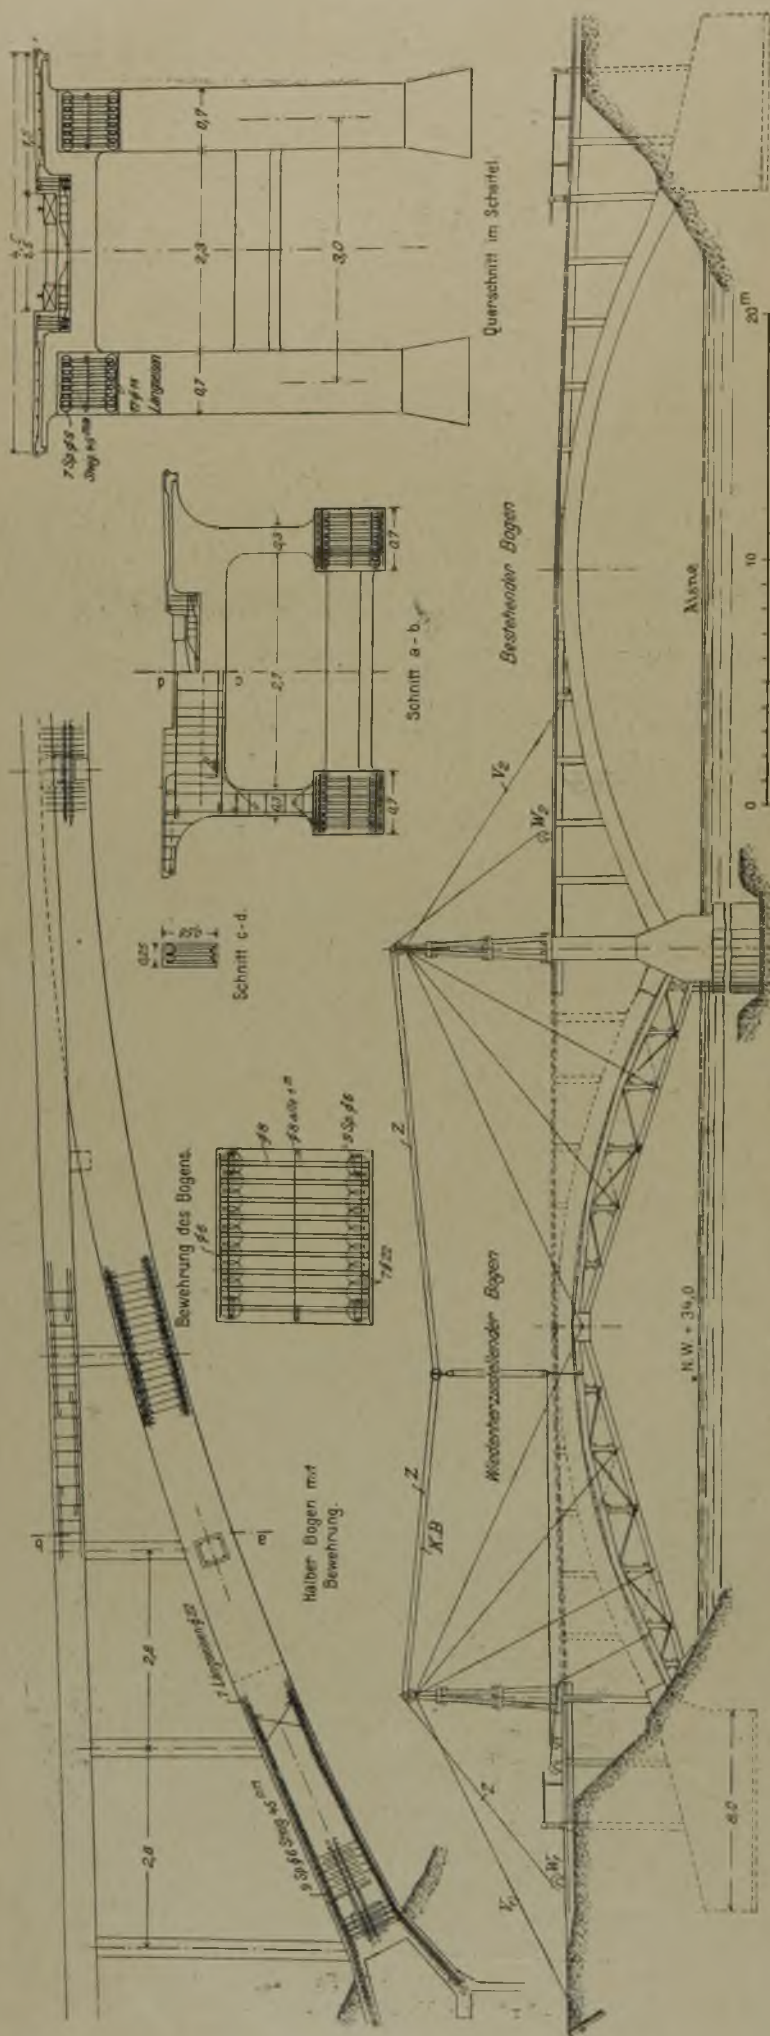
Wiederherstellung der Eisenbeton-Bogenbrücke über die Aisne bei Vie-sur-Aisne. System der Brücke und Bauvorgang.
